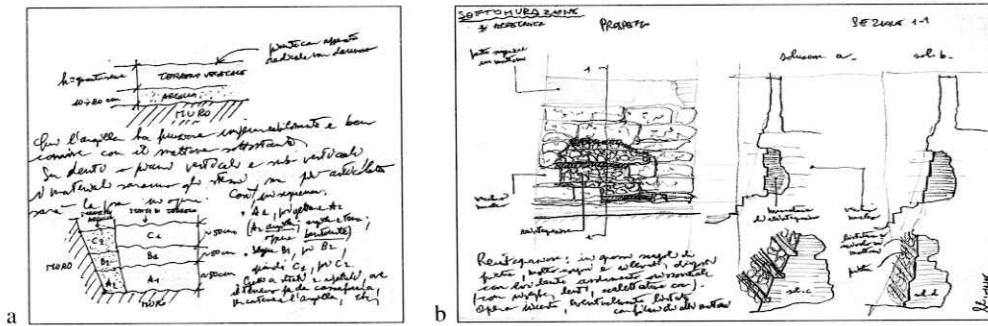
Appunti preliminari all'intervento sul bastione San Prodocimo: a) proposte per la stesura di una coltre di terra con funzione anche impermeabilizzante; b) proposte, in alternativa, per la sottomurazione delle porzioni di calcestruzzo, già minate, a rischio di crollo.
